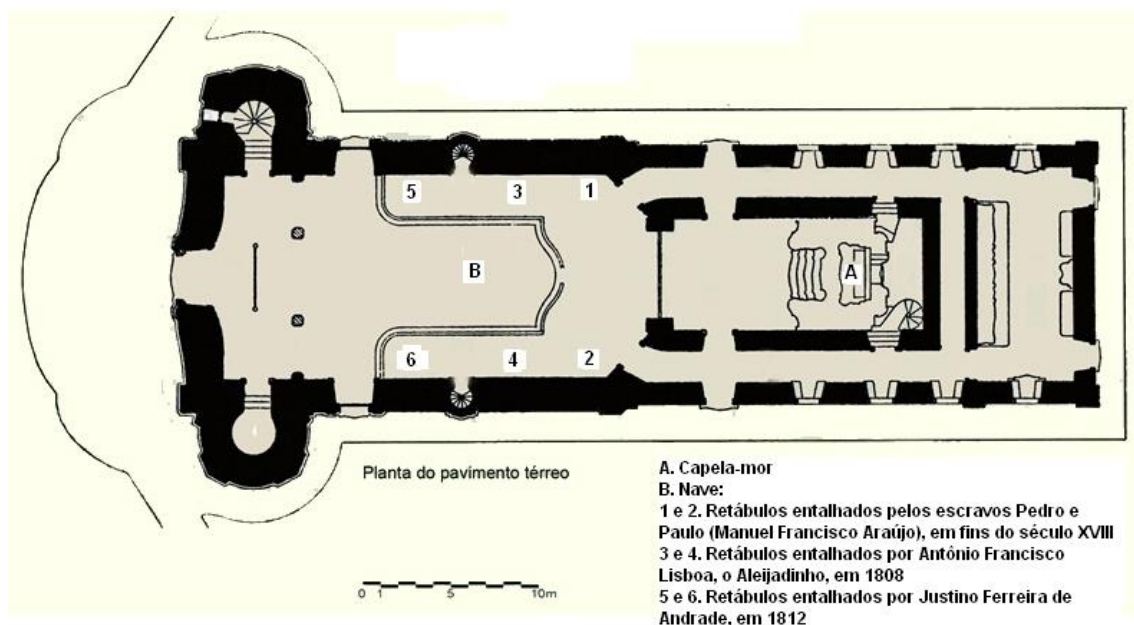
Planta baixa da Igreja da Ordem Terceira de N. Sra. do Carmo de Ouro Preto
